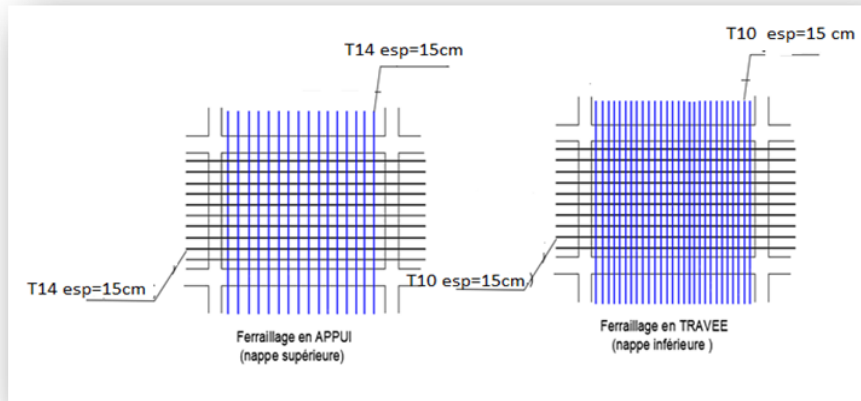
Ferrillage de la dalle pleine étage courant.
